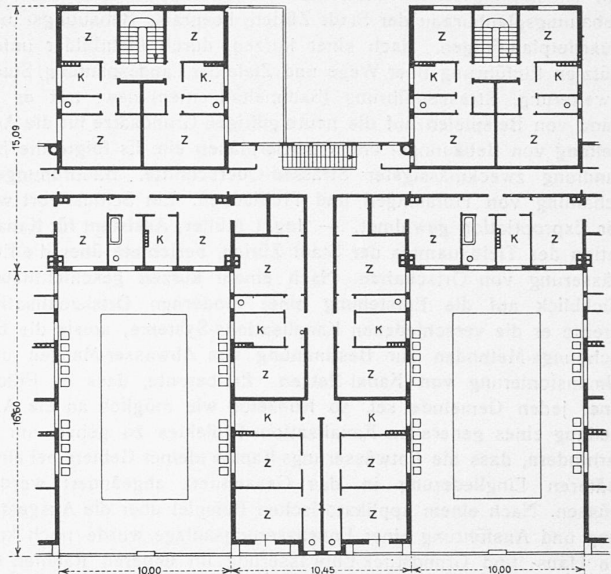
Normaler Grundriss der Wohngeschosse. — Masstab 1 : 400.
